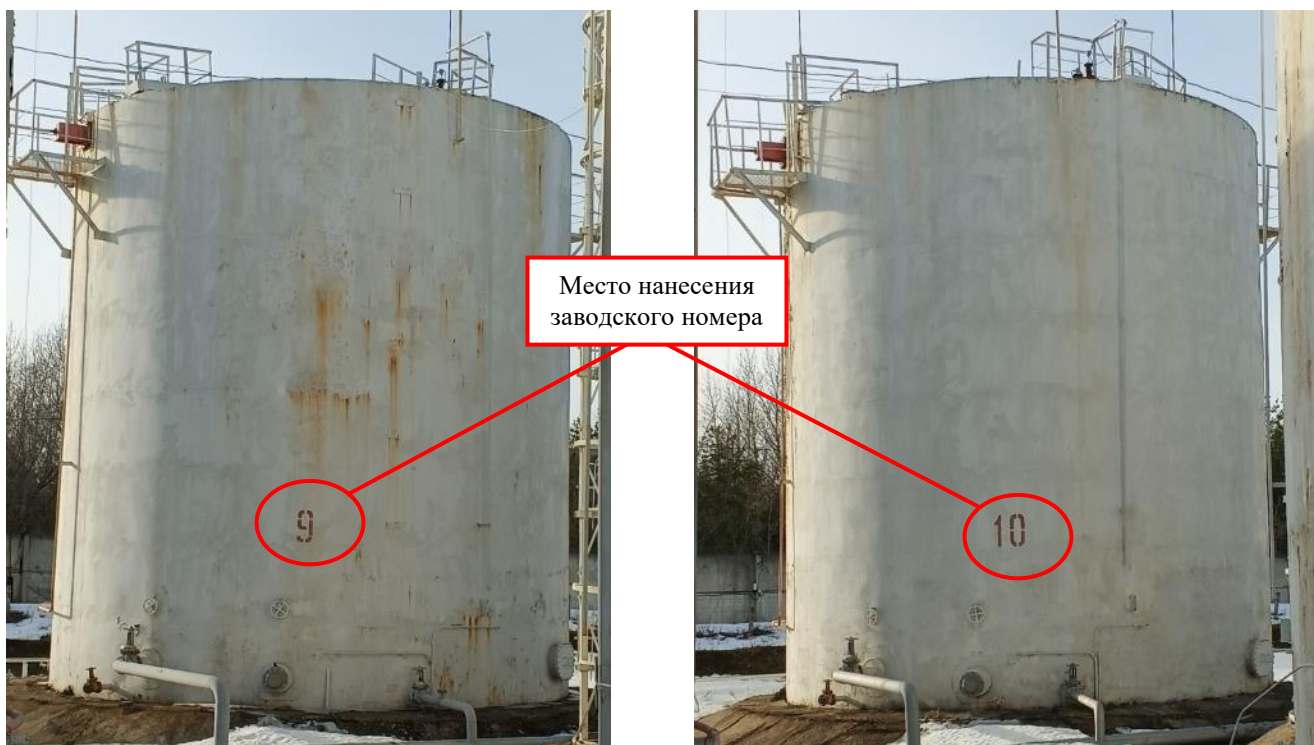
Общий вид резервуара стального вертикального цилиндрического
